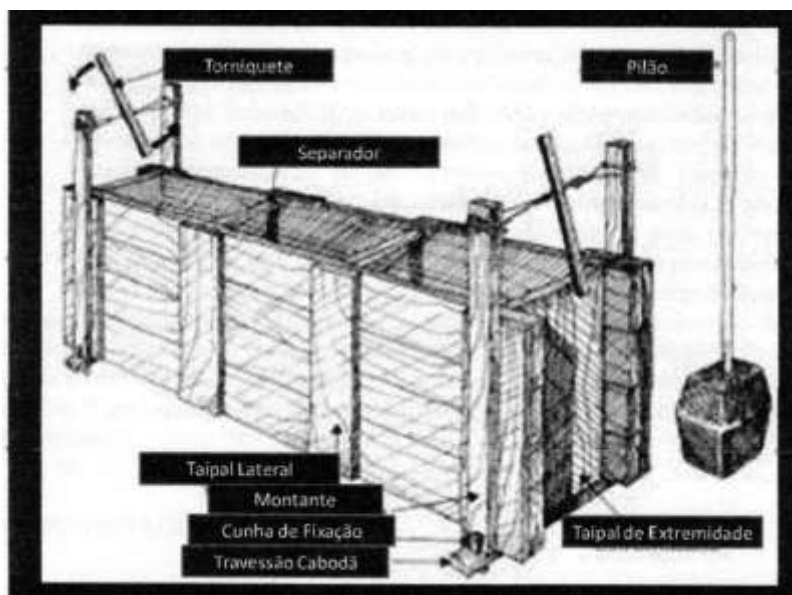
Sistema tradicional de construção da ‘Taipa-de-Pilão’
